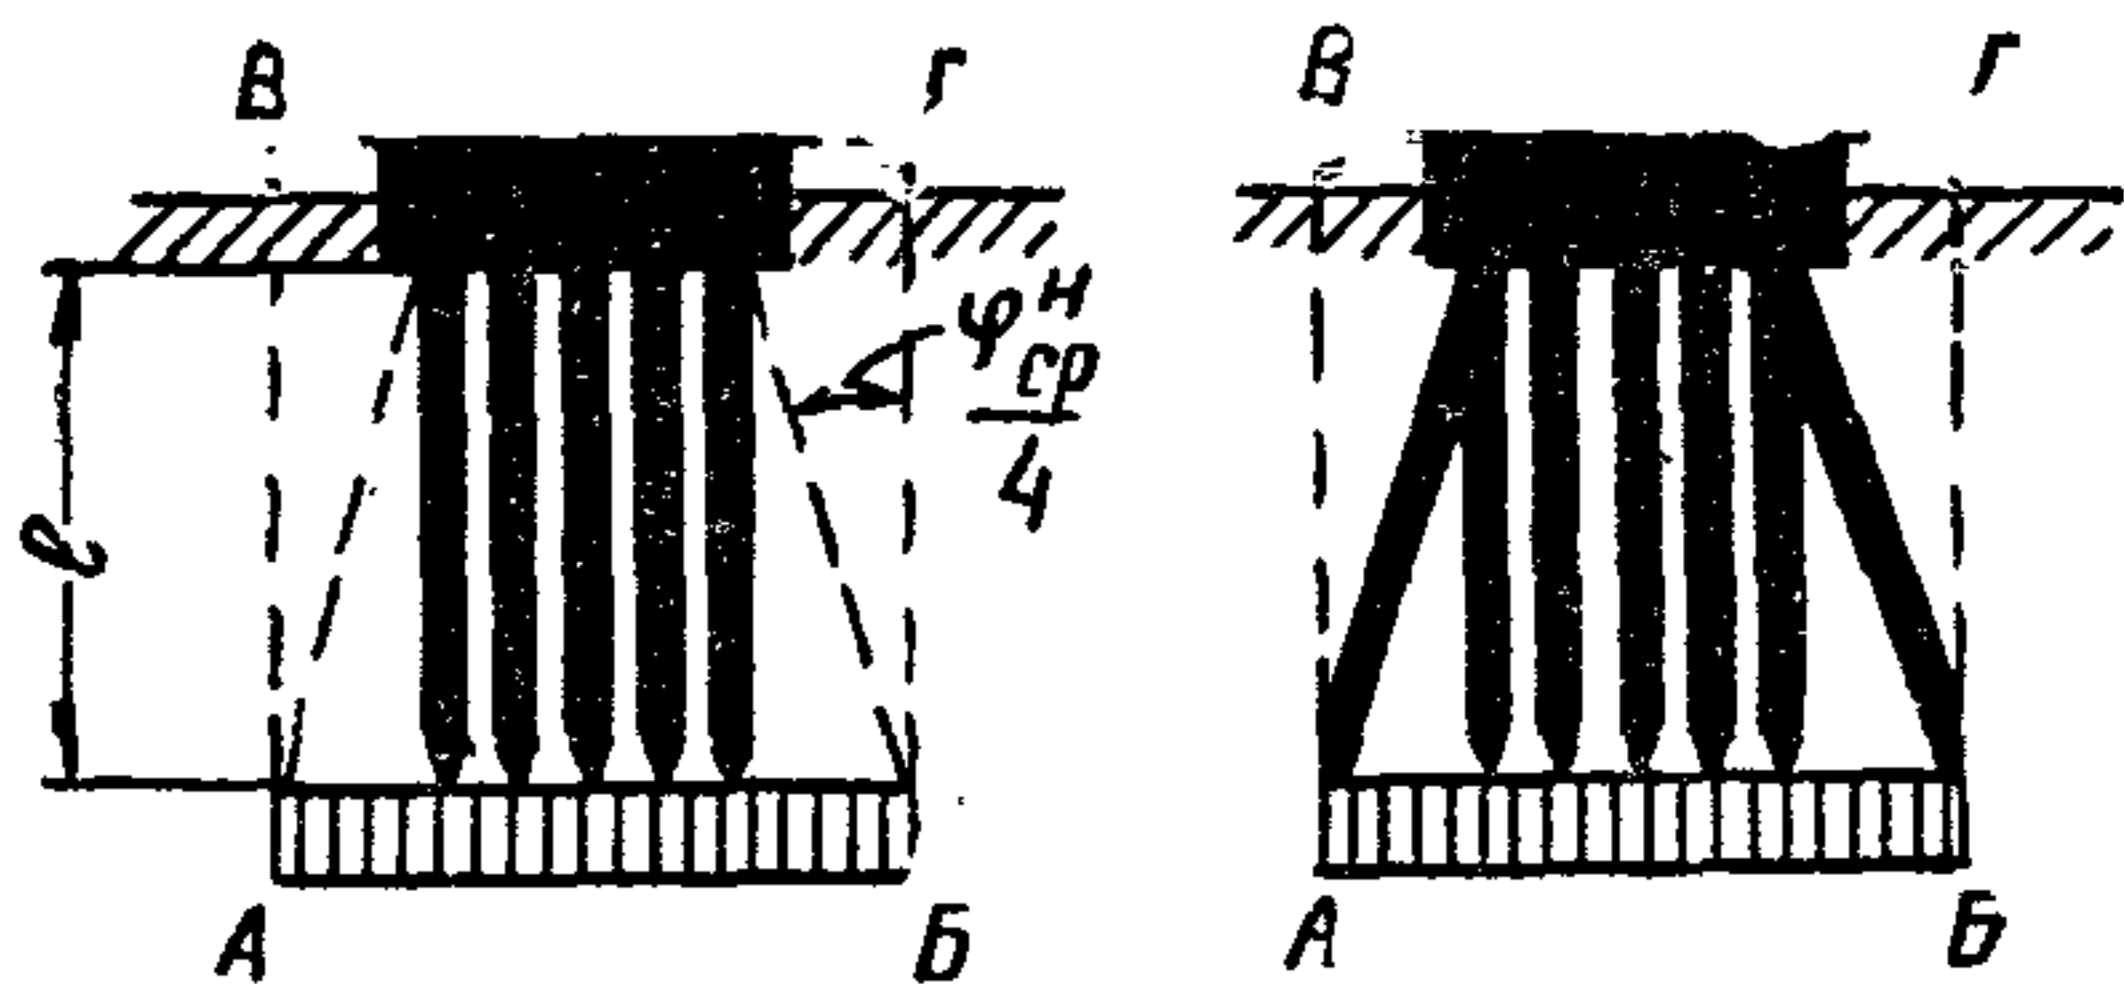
Схема определения границ условного фундамента при расчете осадок свайных фундаментов
